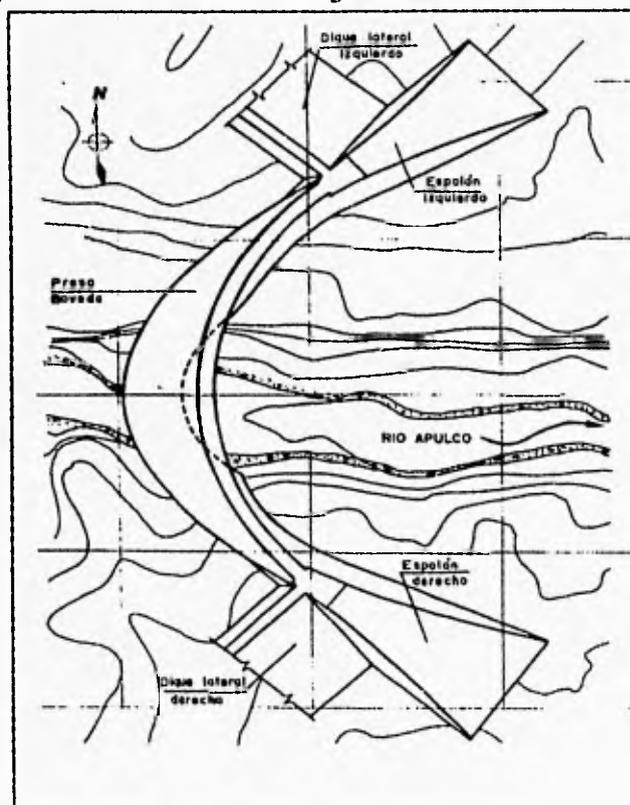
Planta de la presa-bóveda de La Soledad, Edo. de México.
